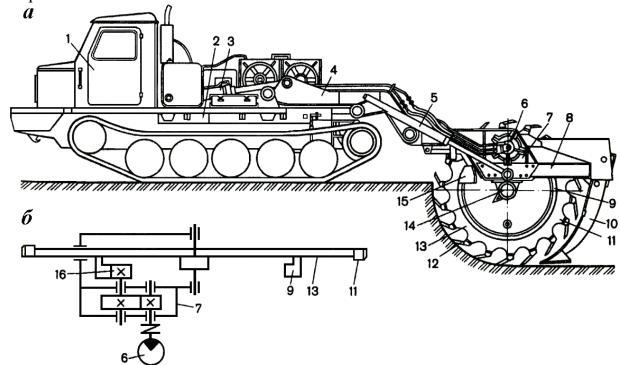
Дисковая щелерезная машина: a – общий вид; δ – кинематическая схема привода ротора
